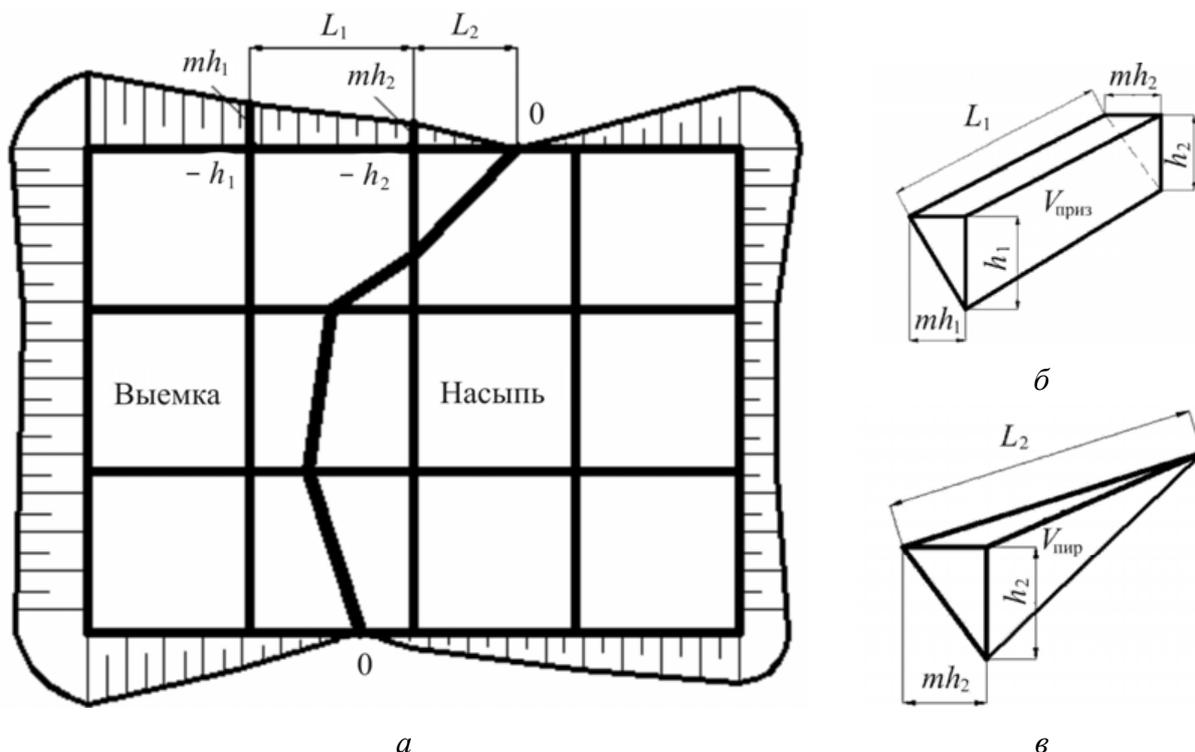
Схема расчета откосов: а — план площадки; б, в — элементарные фигуры
